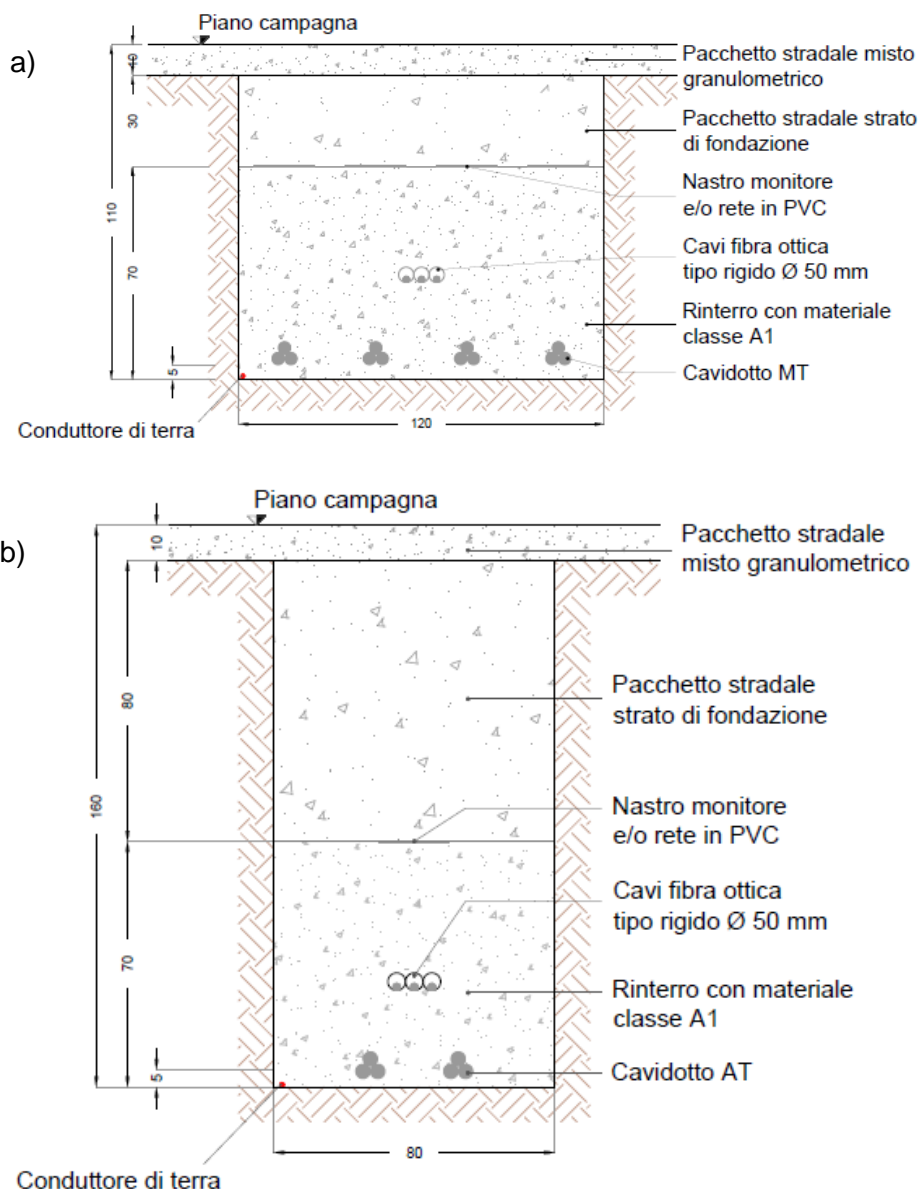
Sezione tipo cavidotto su strada sterrata: (a) Cavidotto 30 kV; (b) Cavidotto 150 kV
